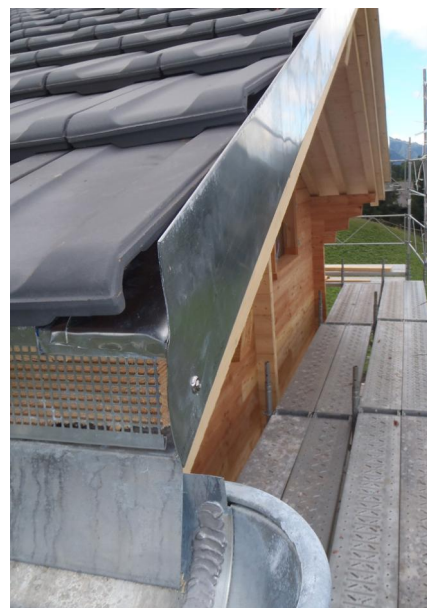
Dachrinne MFH, Archiv Holzbau AG
